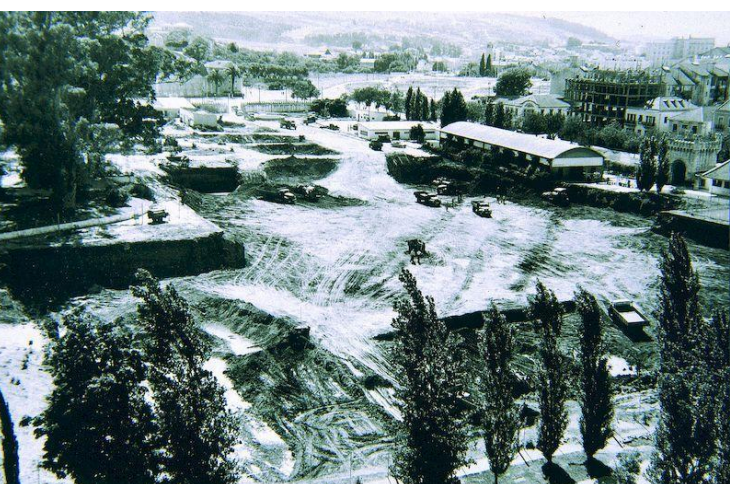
Fotografia das obras da Fundação Calouste Gulbenkian
